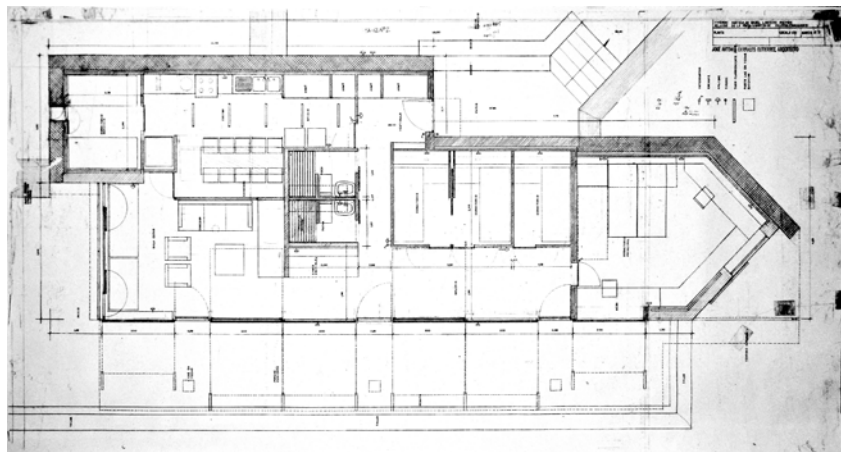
Archivo J.A. Corrales, casa Lantero Rozpide, "la Viña", planta y detalles carpinterías principales.
